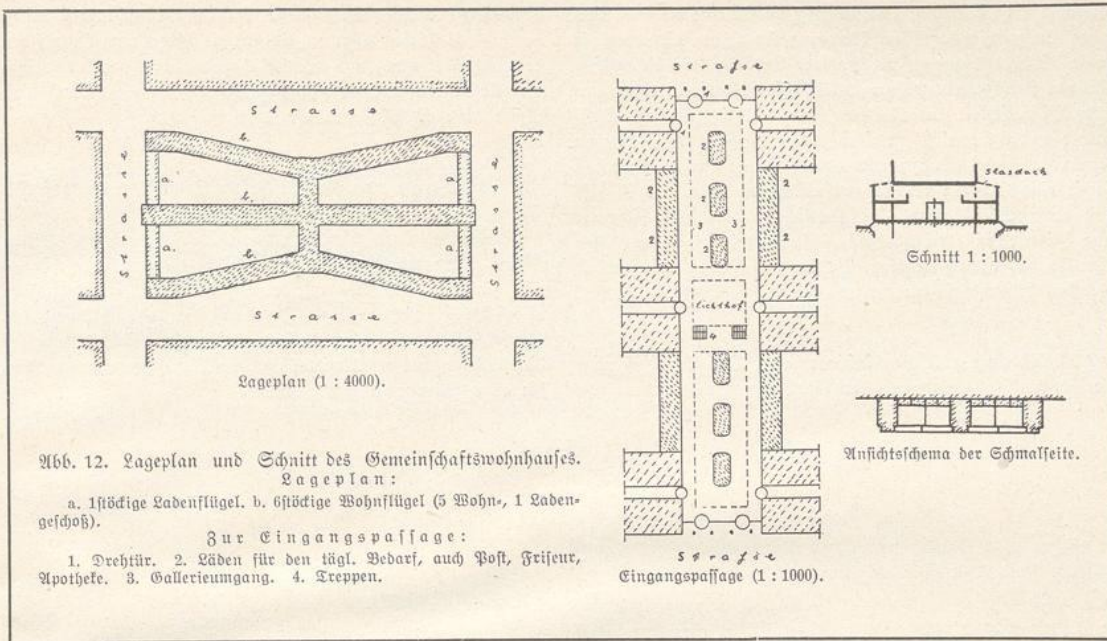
Lageplan und Schnitt des Gemeinschaftswohnhauses.
